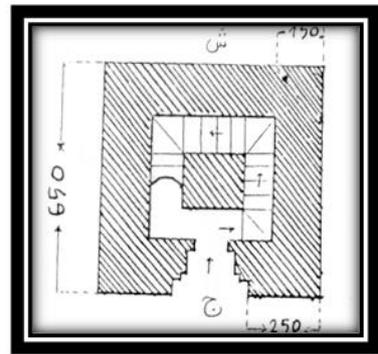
le minaret Gala des Banī Hamad: plan du Minaret
